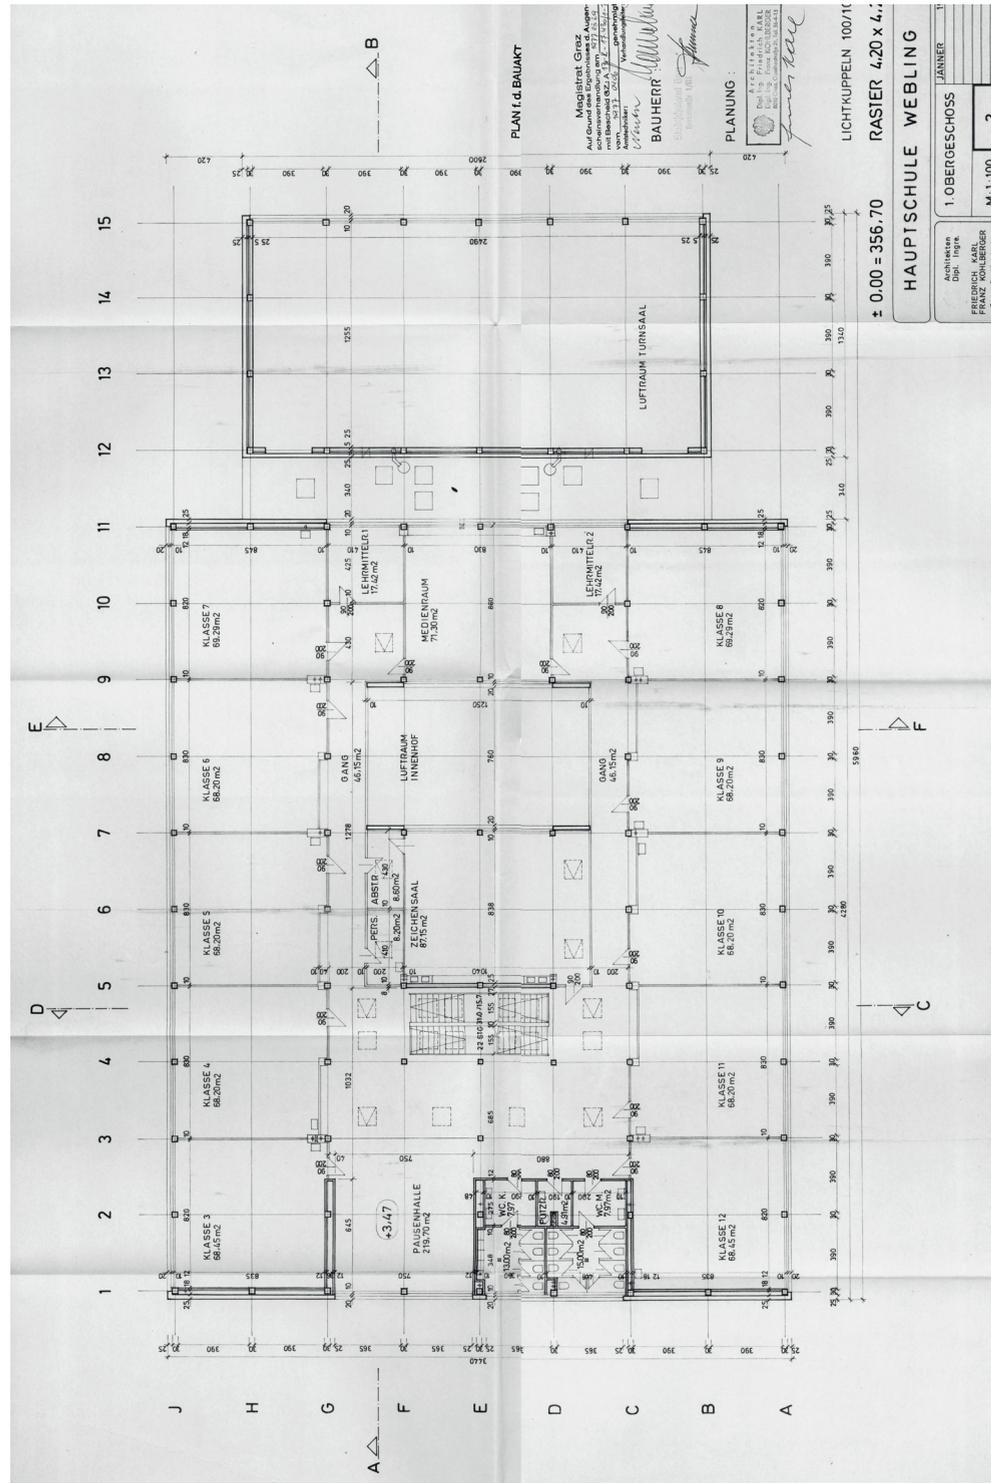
Grundriss OG HS, 1977 Stand Einreichplanung
